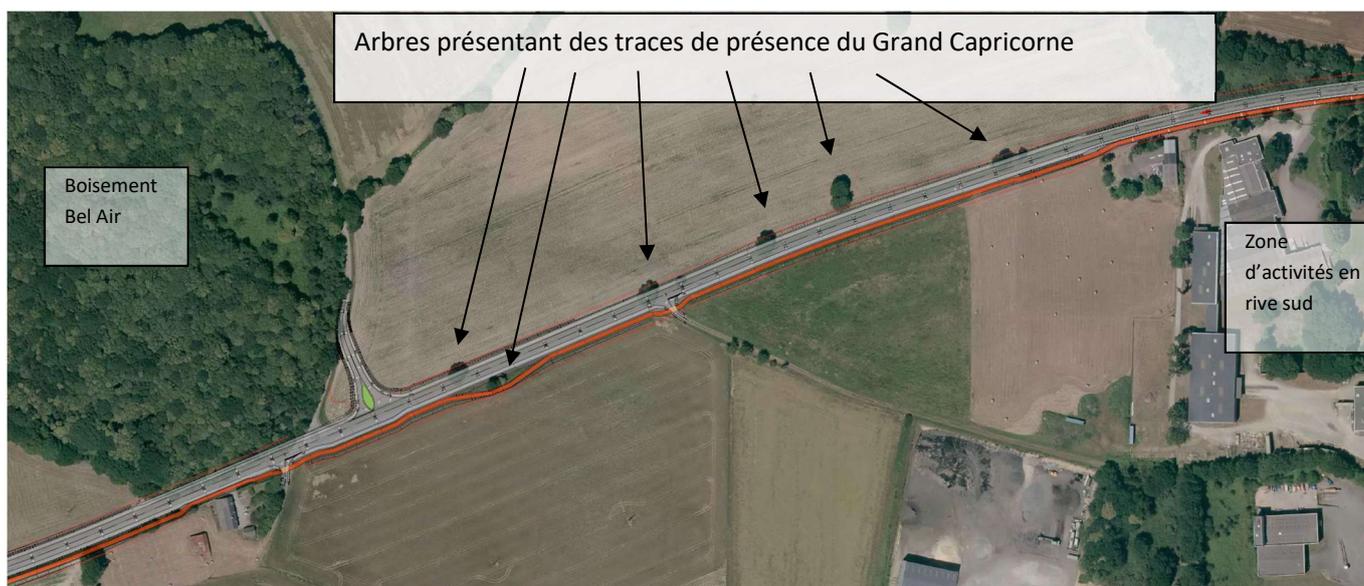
EXTRAIT DE LA VUE EN PLAN DE LA FUTURE ROUTE (GRIS CLAIR ET FONCE) ET DE LA PISTE CYCLABLE (ROUGE)
